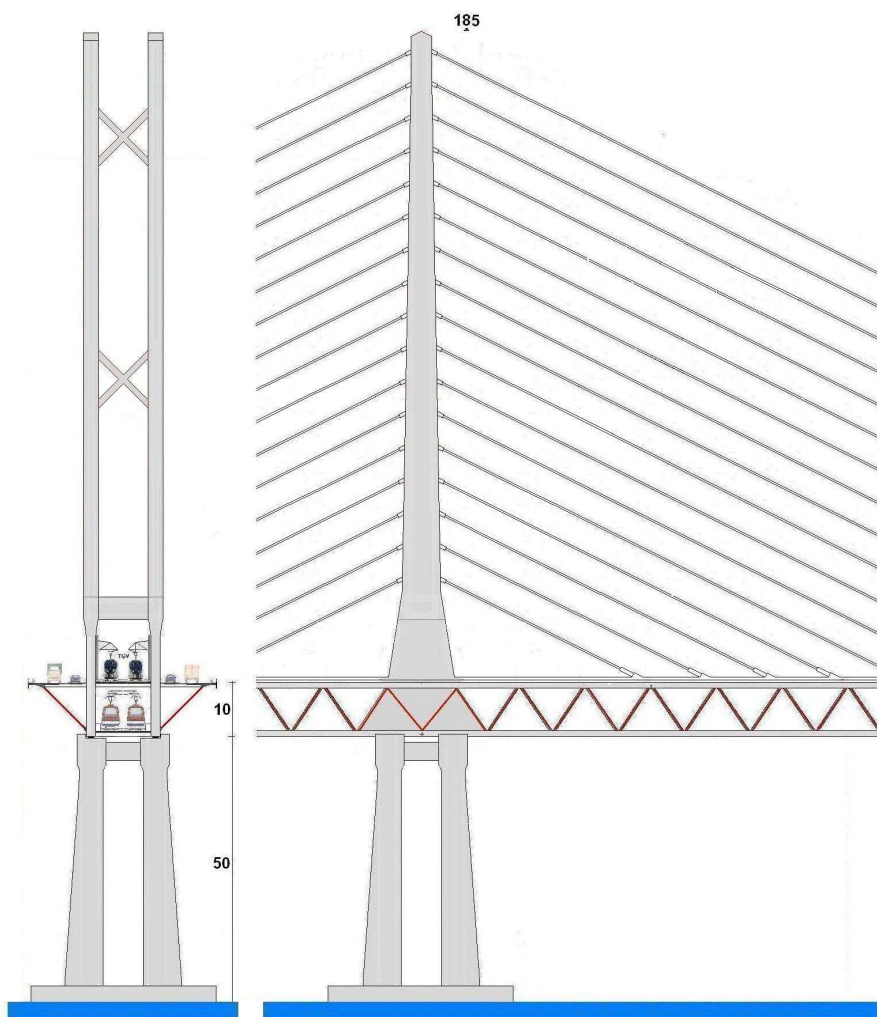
Perfil da ponte na zona do canal de Cabo Ruivo - Detalhes
